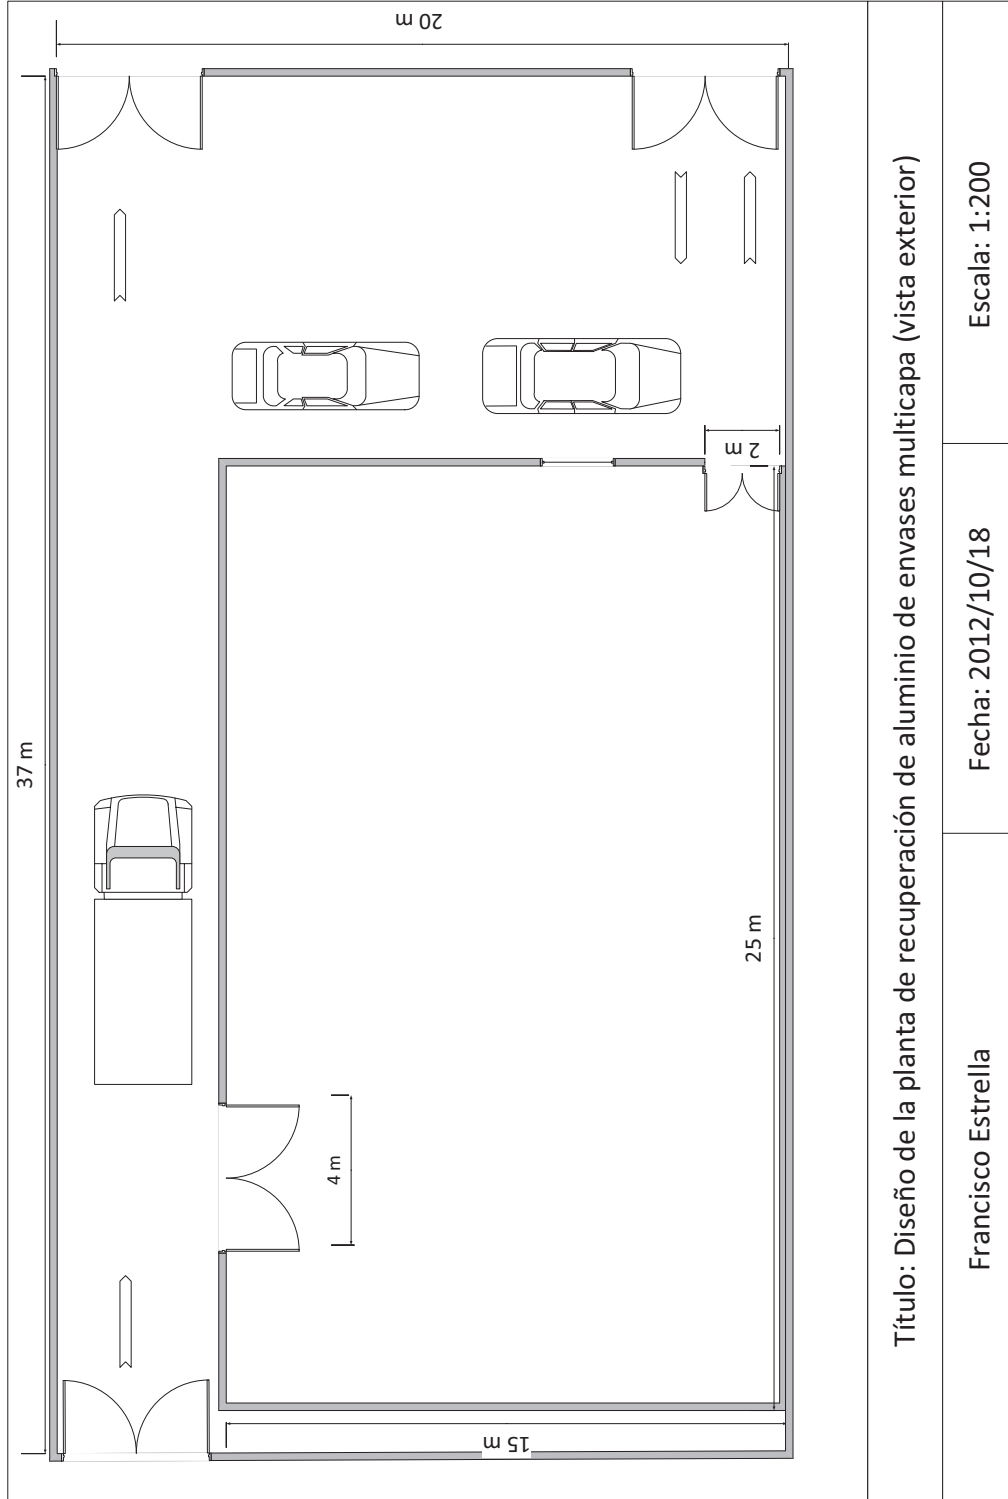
Vista superior del dimensionamiento exterior de la planta
